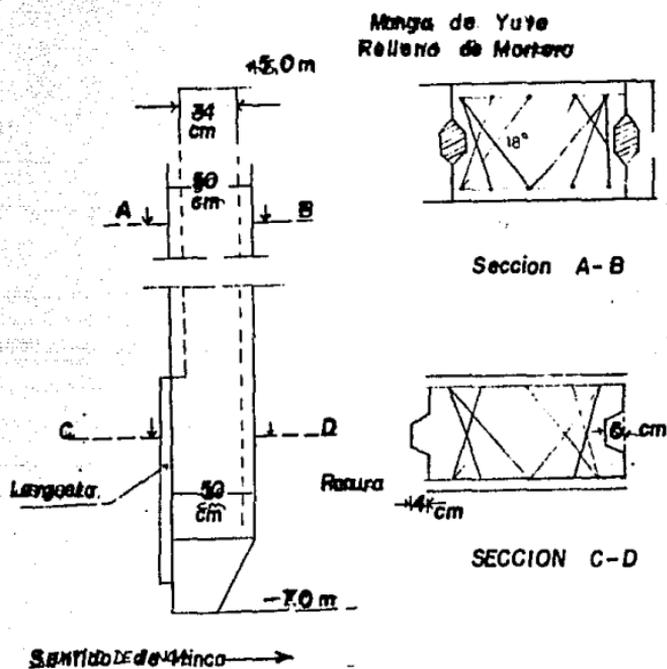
Tabla estaca de Hormigón Armado
